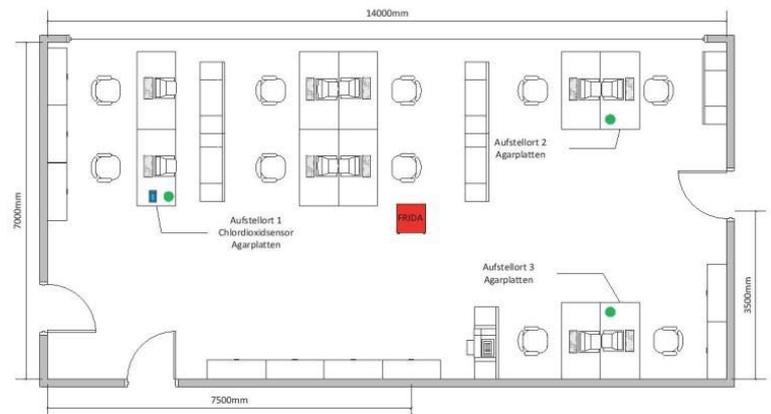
Der Grundriss veranschaulicht die Raumgröße und -ausstattung sowie den Versuchsaufbau
